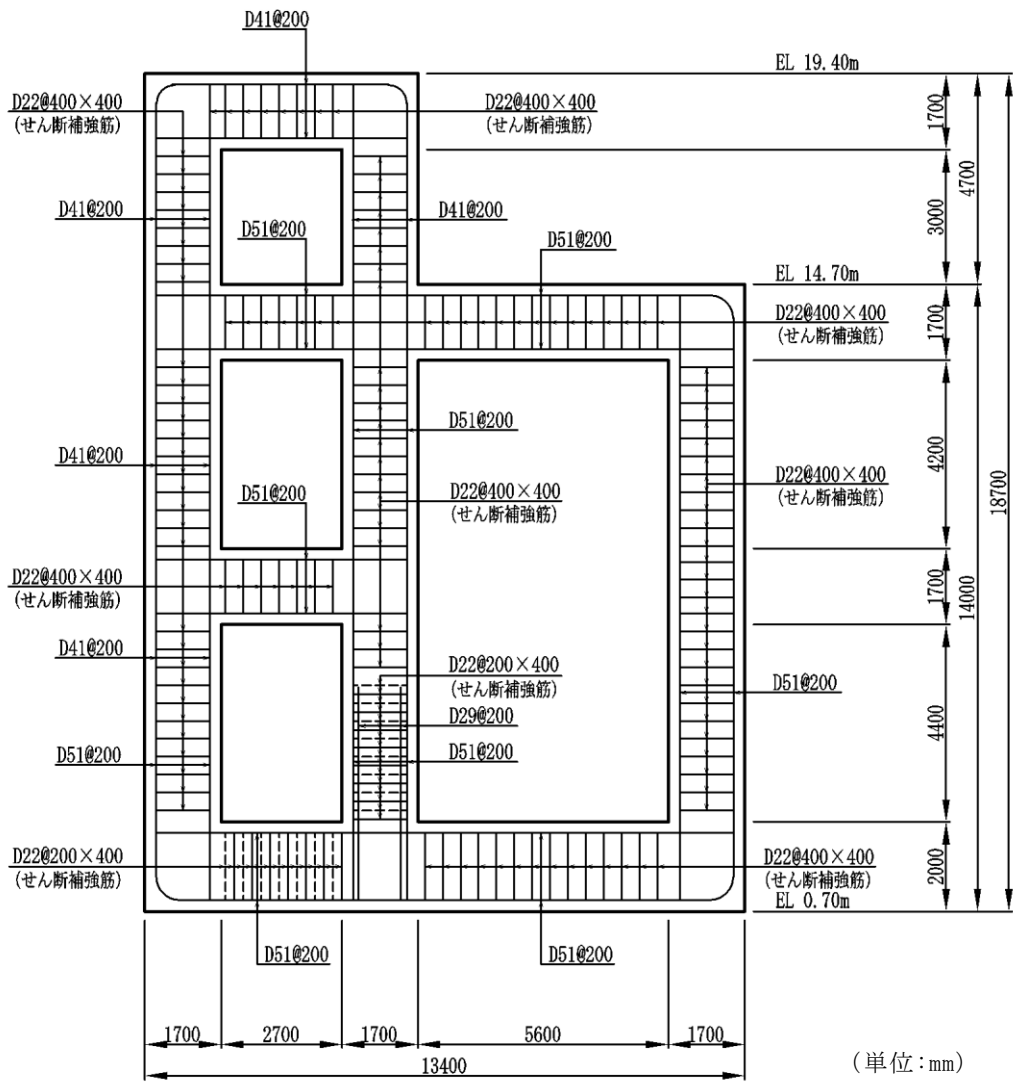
第 1 ベントフィルタ格納槽概略配筋図 (A-A 断面)
